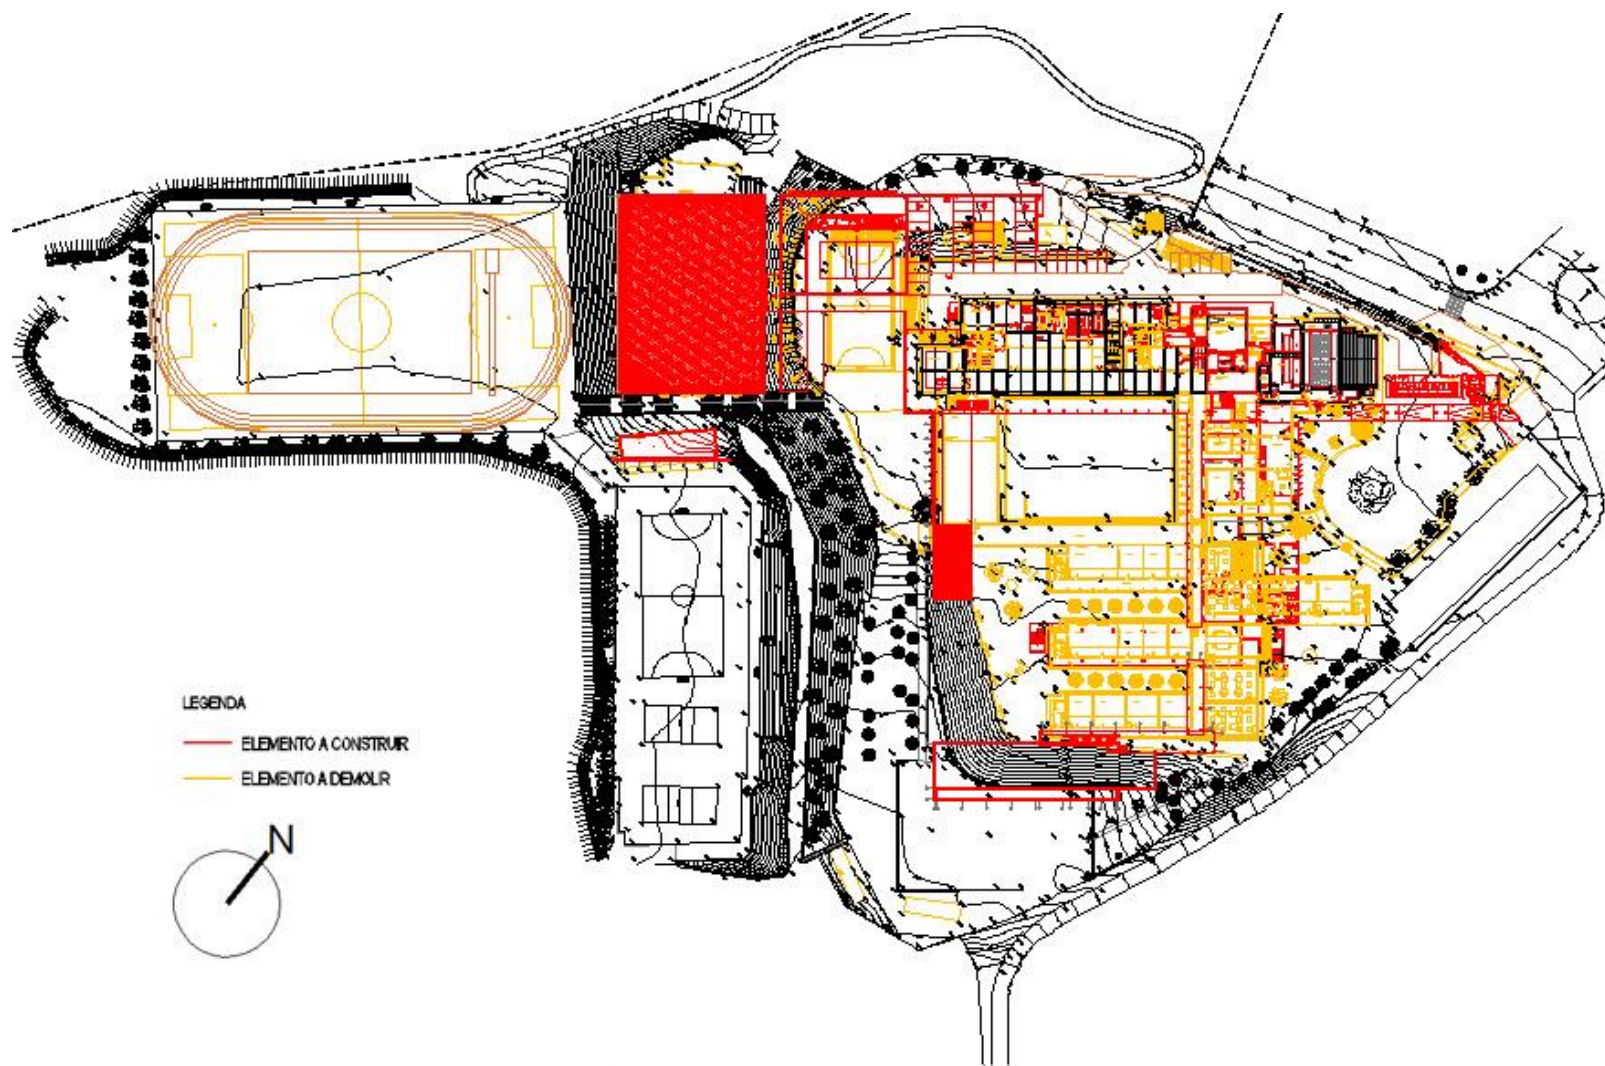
Planta de implantação da E.S. Dr. Manuel Fernandes
